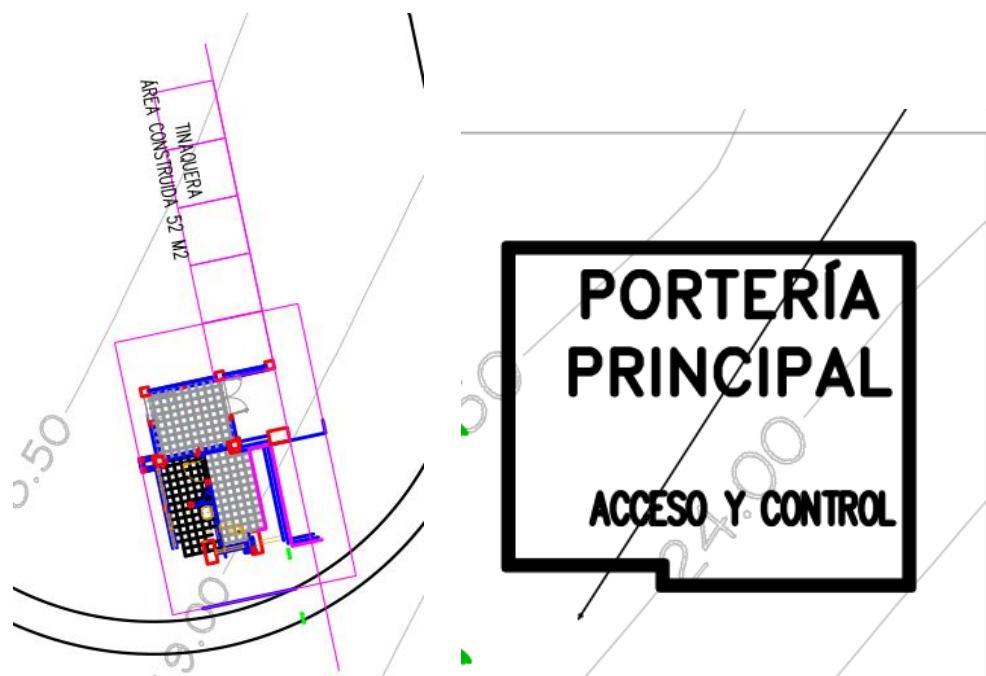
Planta de las Dos (2) garitas o portería (principal y secundaria)
